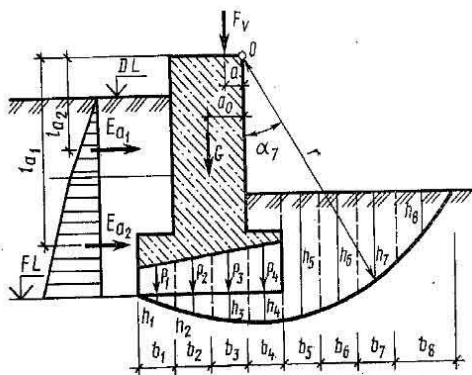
Схема к расчету устойчивости фундамента методом круглоцилиндрических поверхностей скольжения
